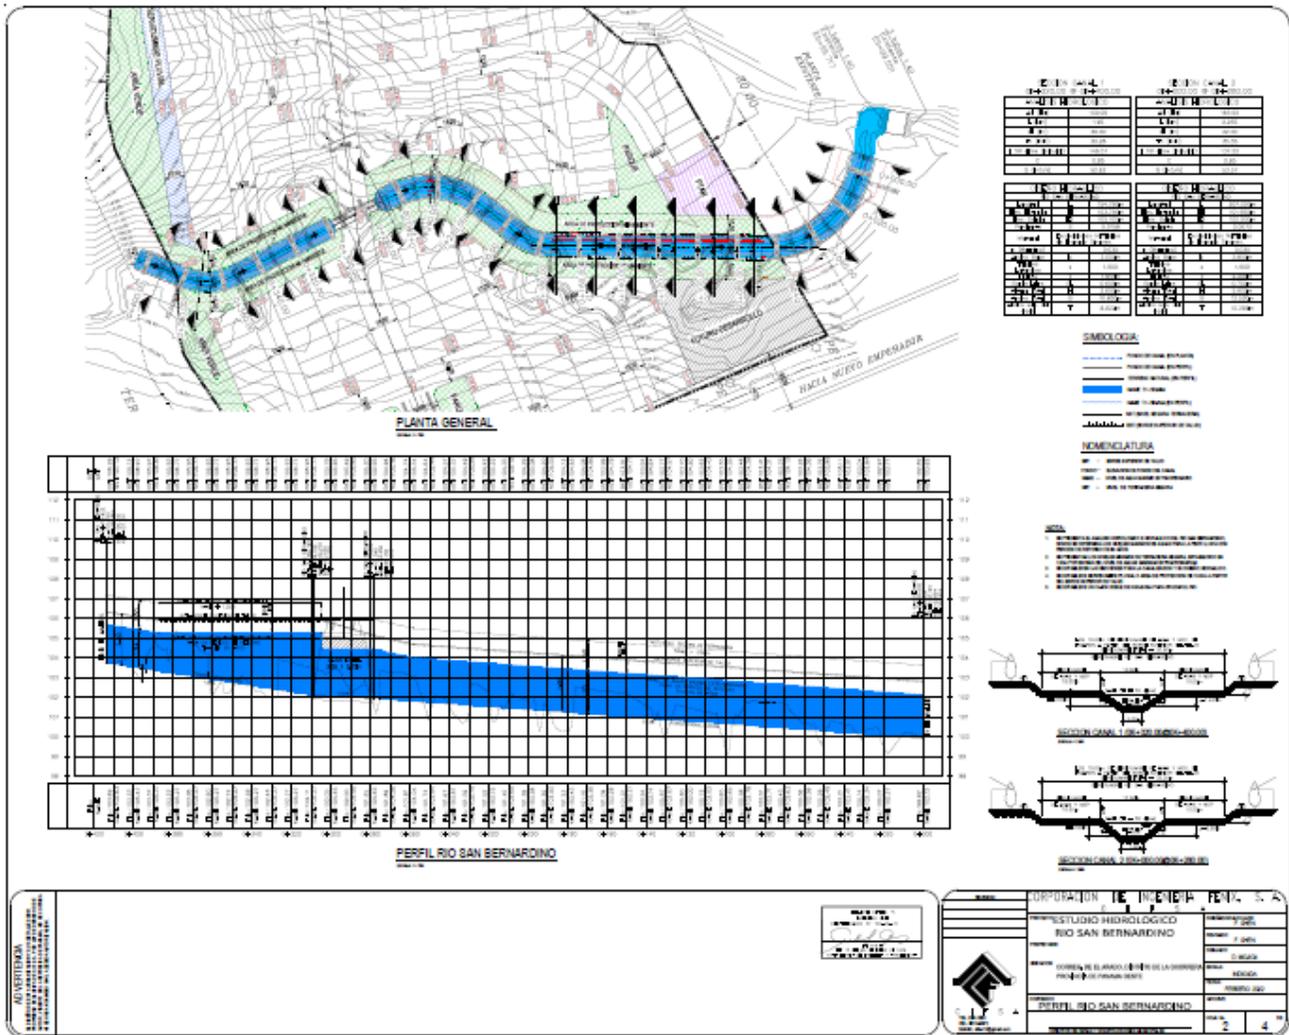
Vista de las obras civiles sobre la fuente hídrica, fuente: Promotor.
